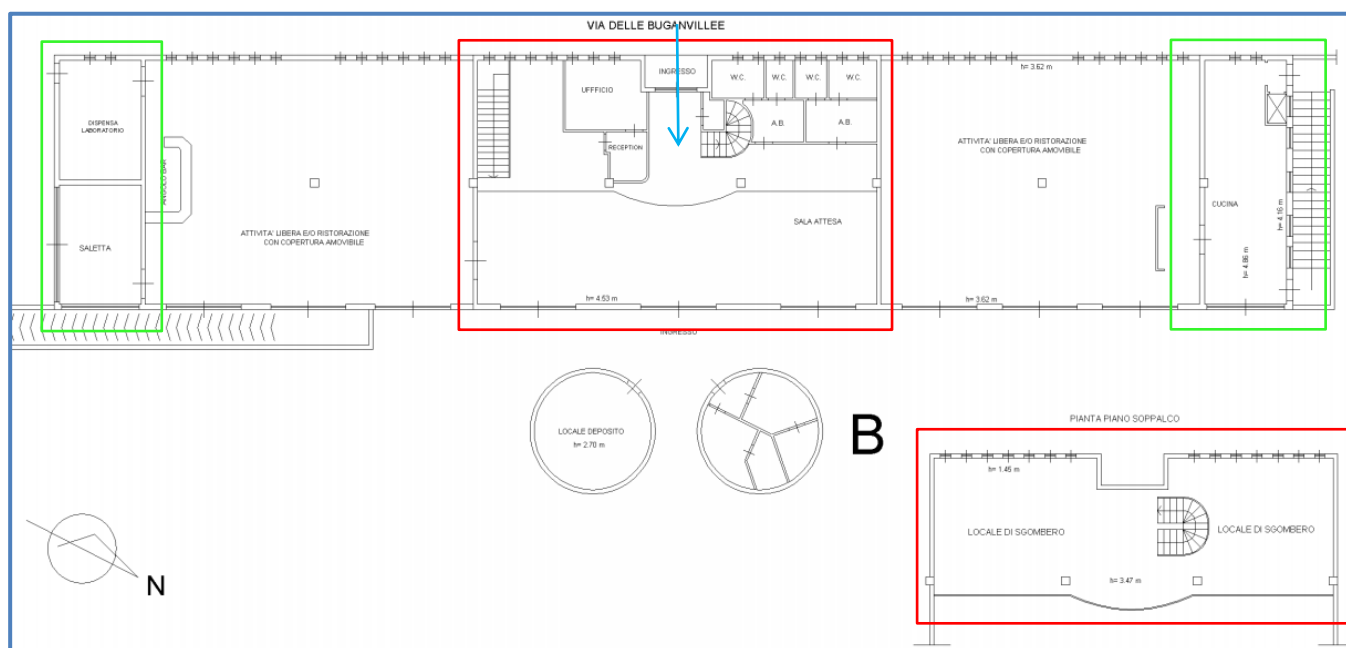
estratto della planimetria catastale del piano terra e soppalco del mappale 758 sub.1
